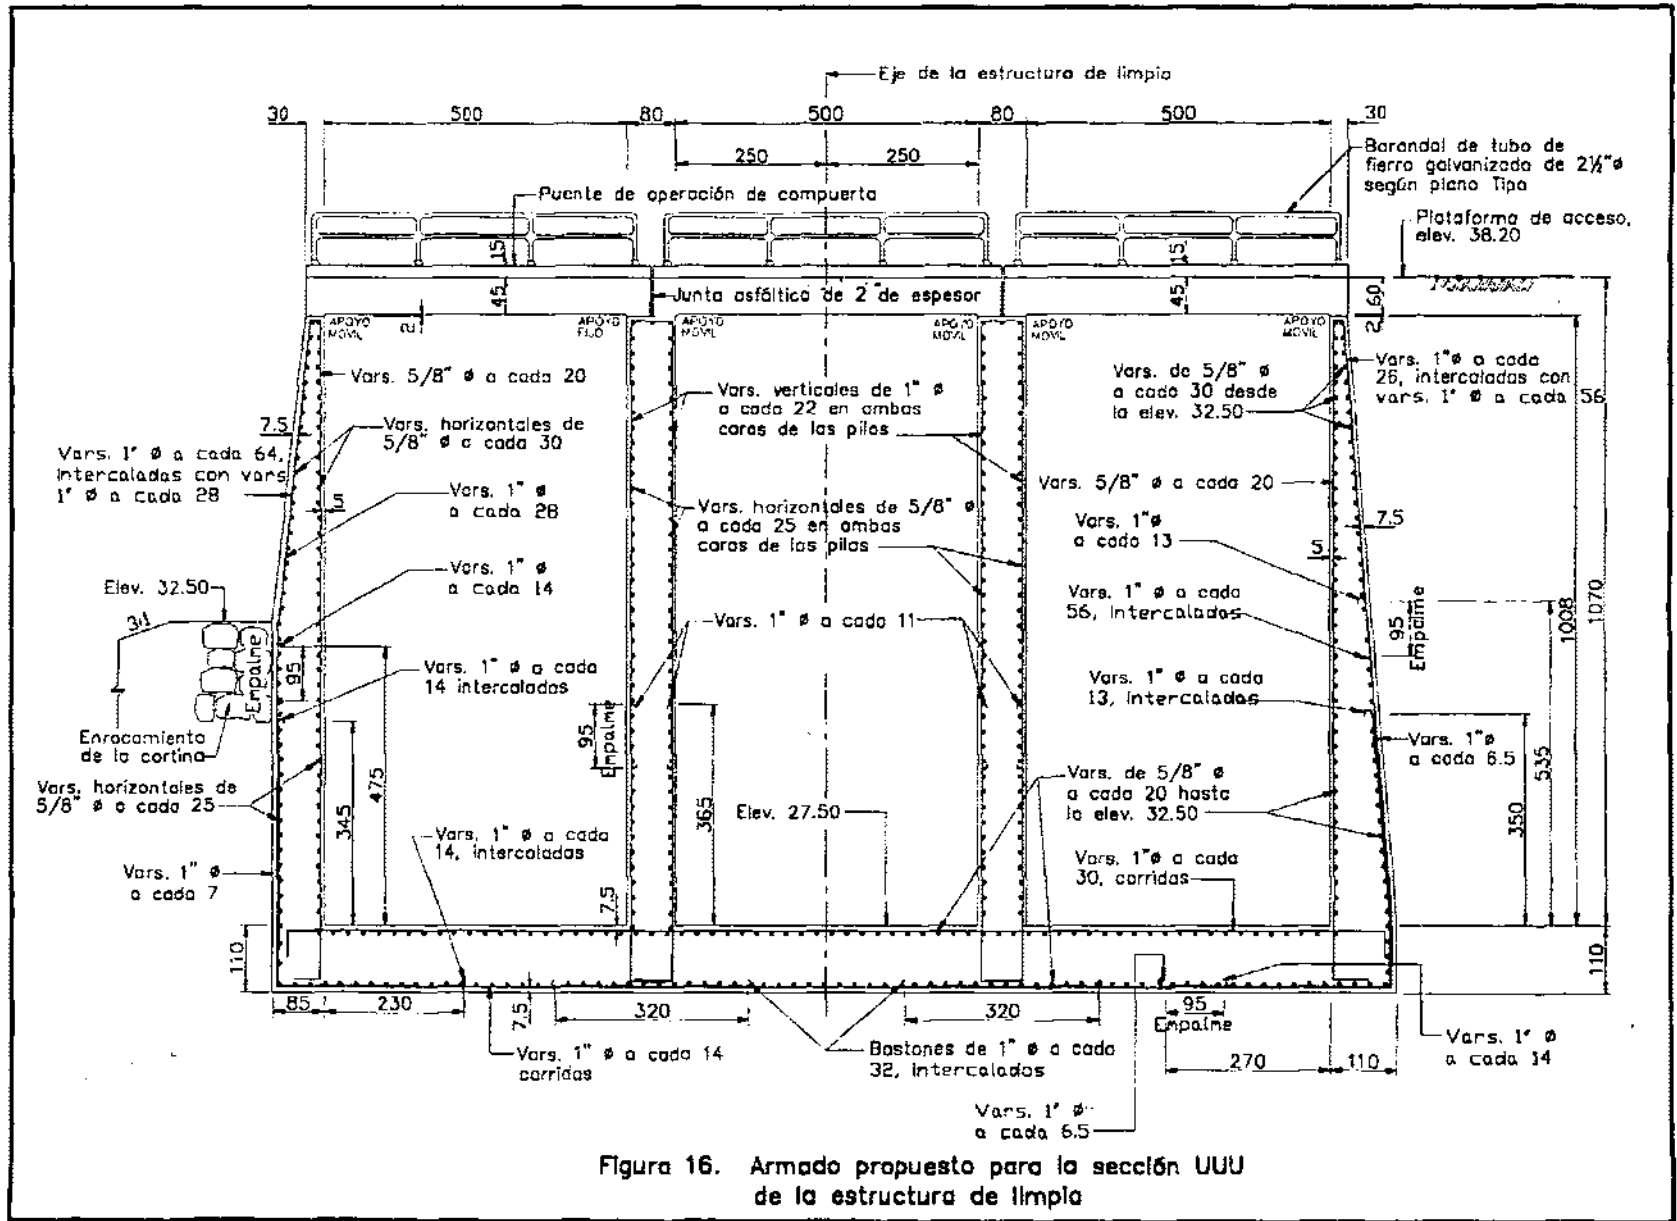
Armado propuesto para la sección UUU de la estructura de limpia
